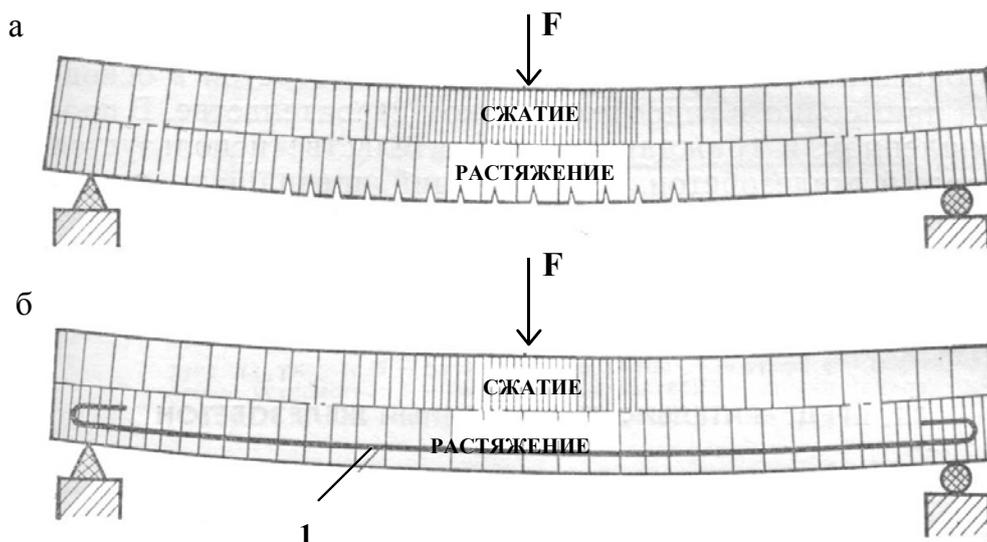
Неармированная бетонная (а) и армированная (б) балки:
